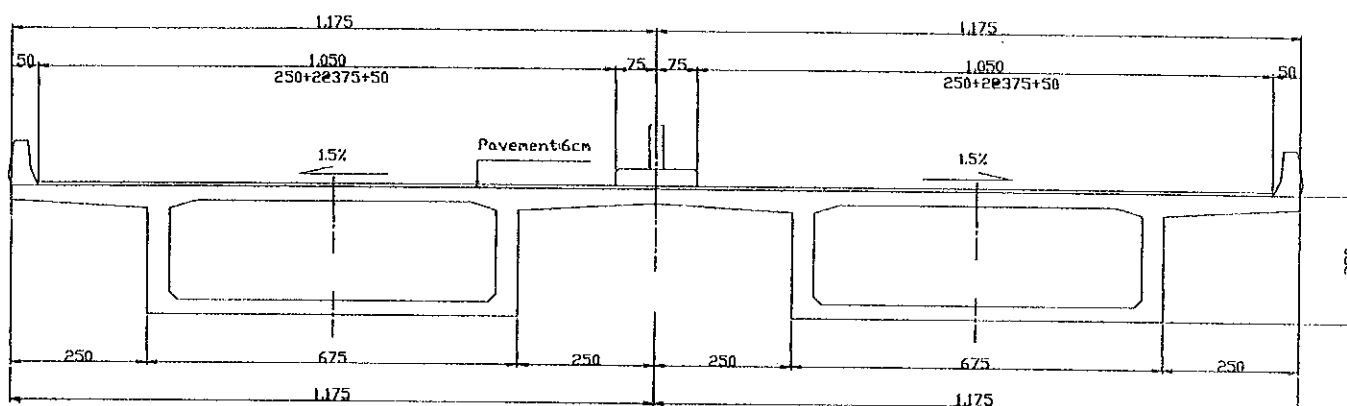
スパン $L_0=50\text{m}$: PCポステン箱桁橋の標準断面図
